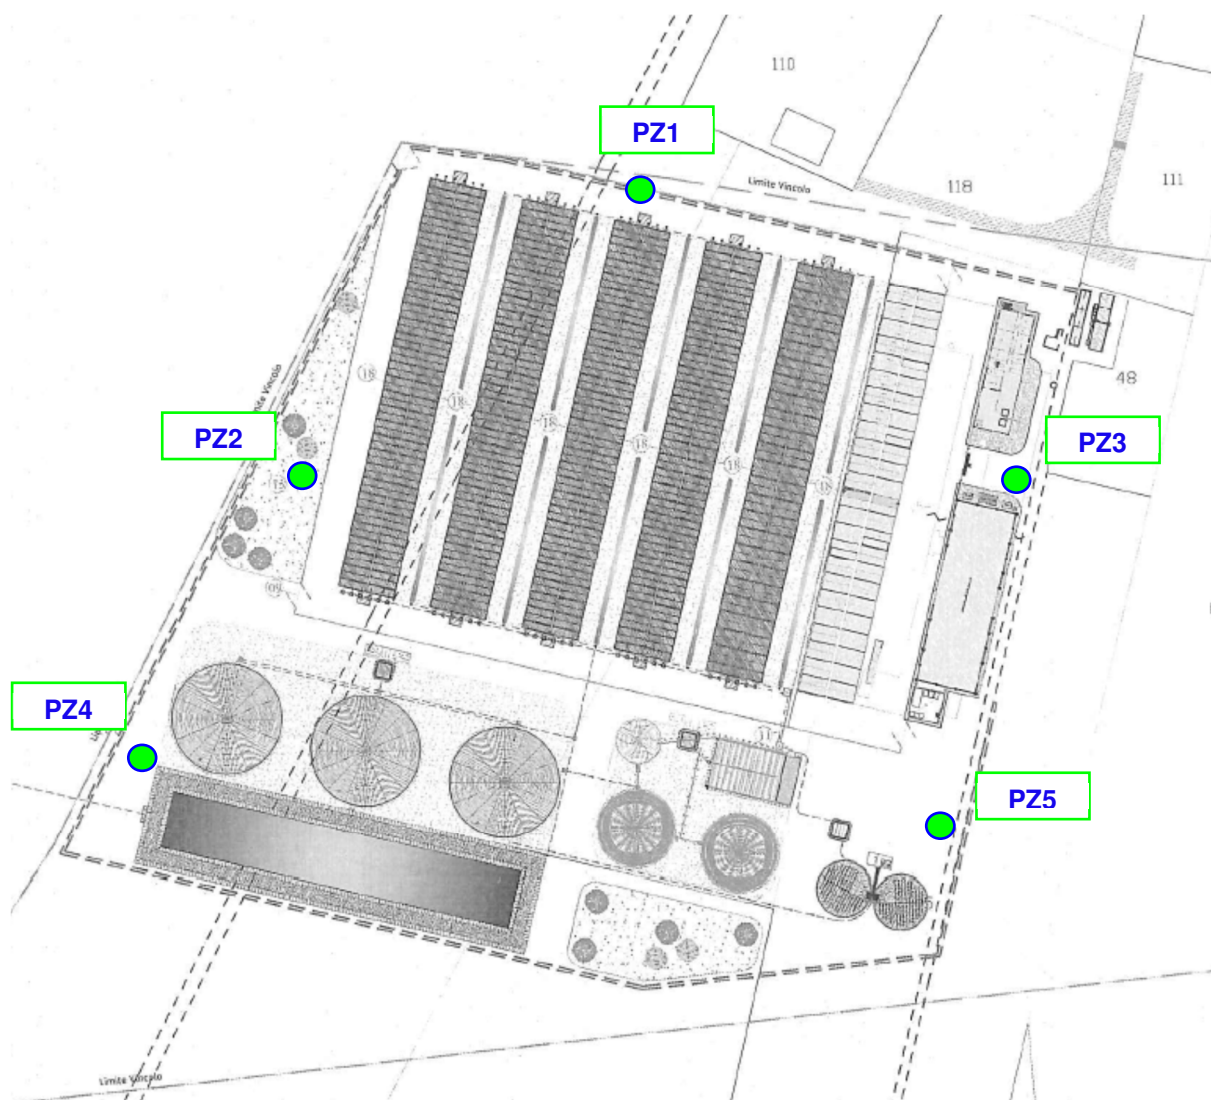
Estratto di planimetria di progetto con ubicazione dei punti di monitoraggio della falda freatica.
